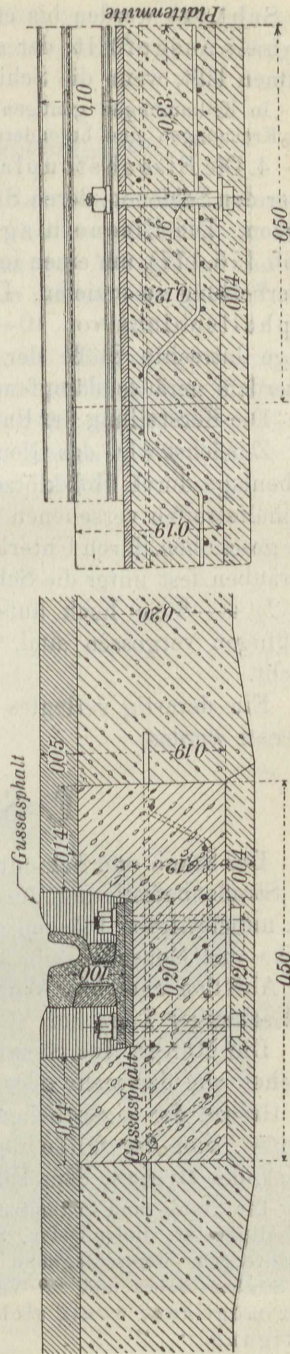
Auflagerung von Straßenbahnschienen in Stampfasphaltpflaster auf Eisenbetonplatten.
